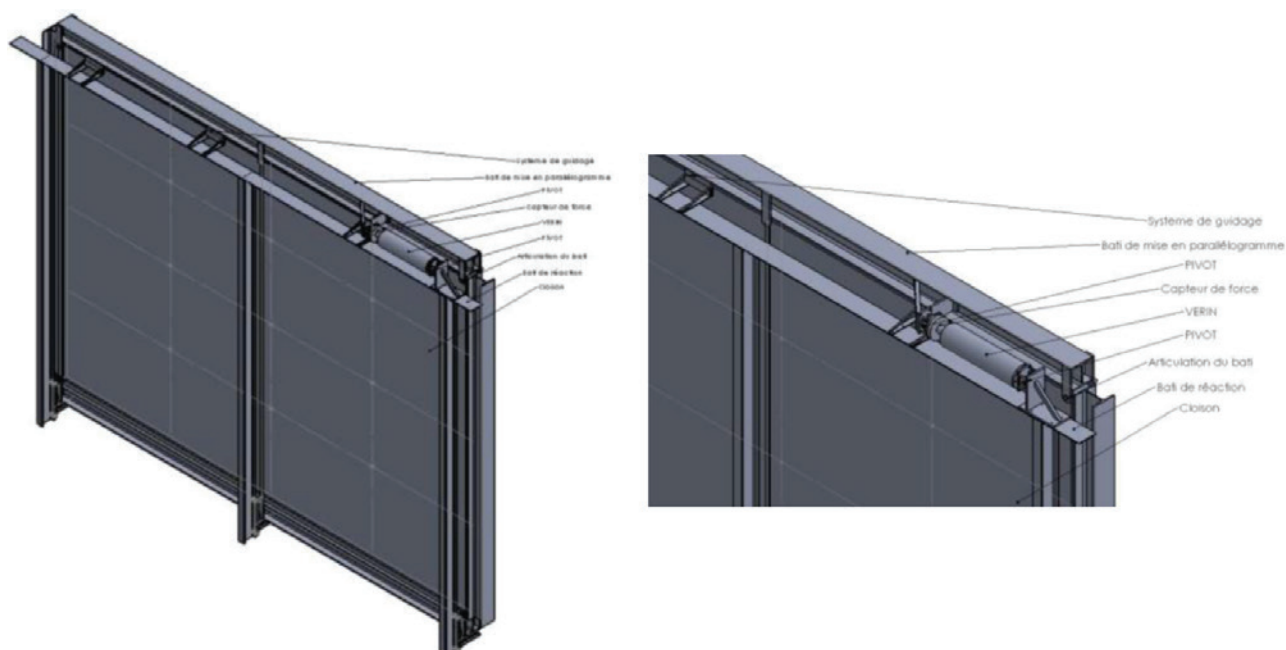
Principe de chargement – Maquette de hauteur 5,0 m
